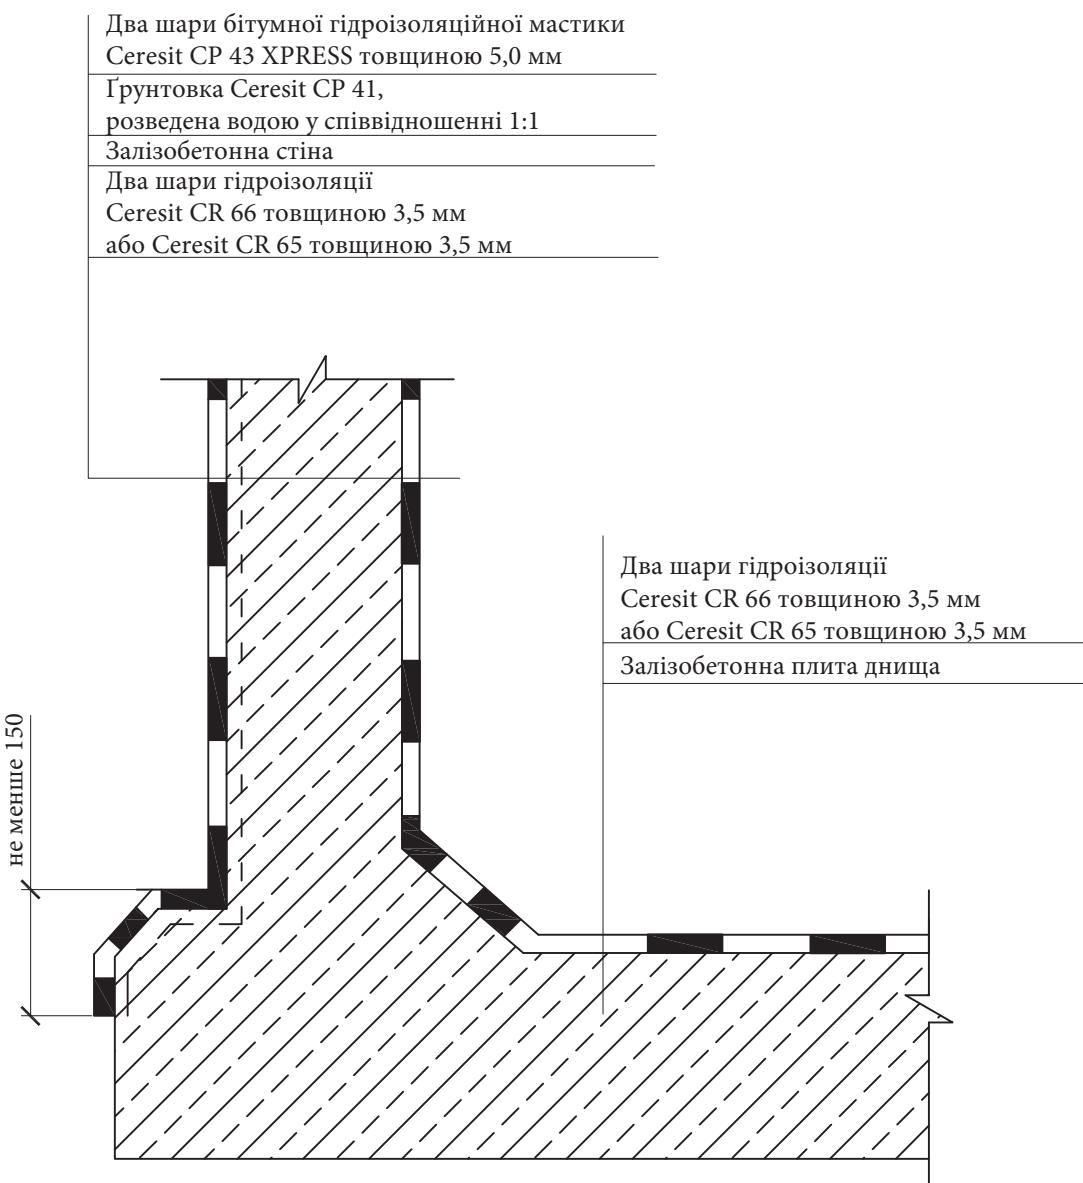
Конструкція системи гідроізоляції монолітних бетонних пожежних ємностей
